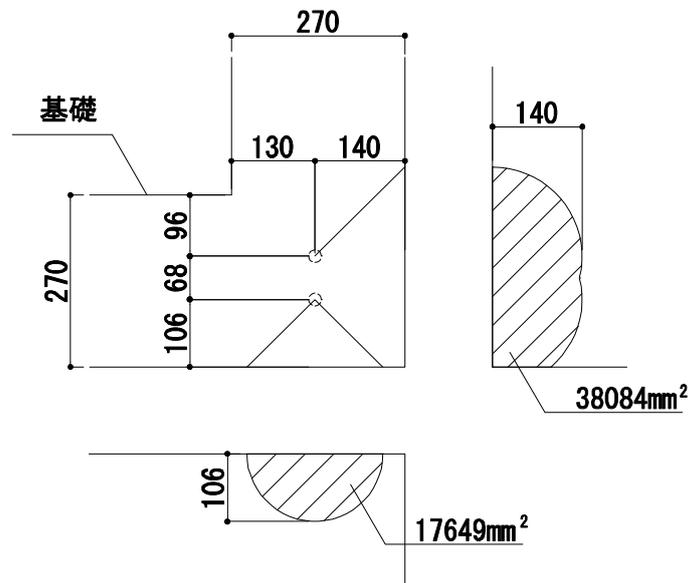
アンカーボルトの側面におけるコーン状破壊面の有効水平投影面積
